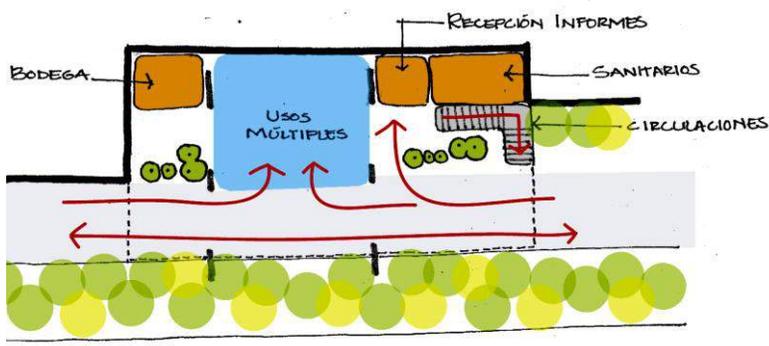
Zonificación de áreas Esquema 2. Planta Baja.
